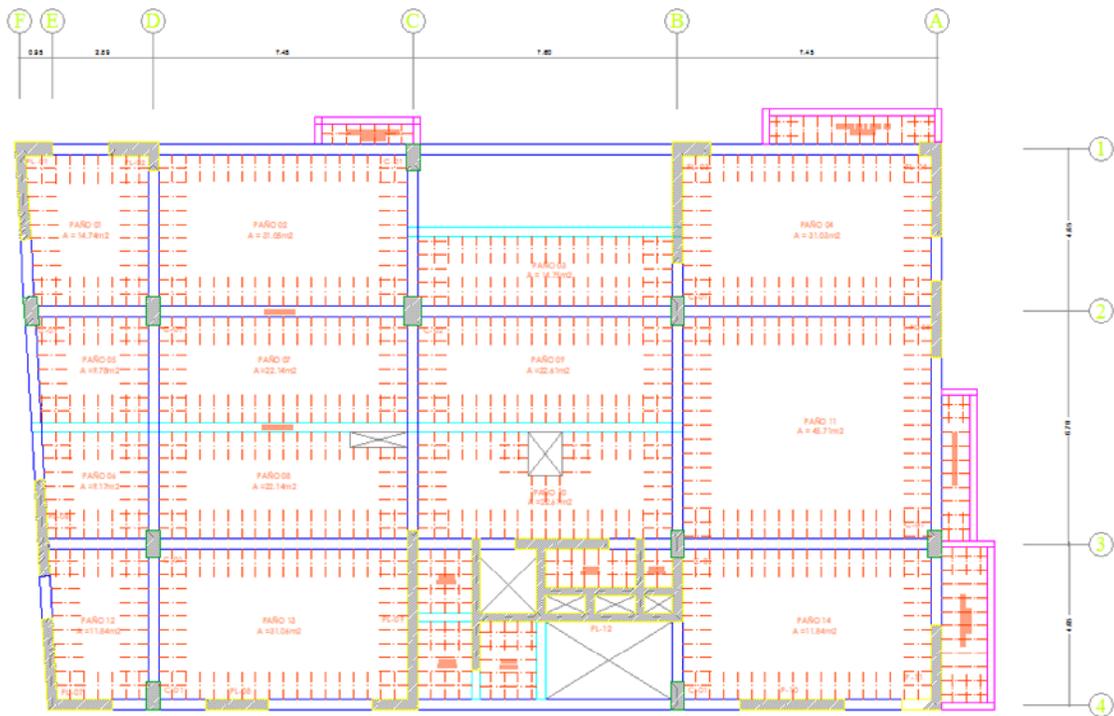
Dirección del Aligerado en Planta – 9no piso
